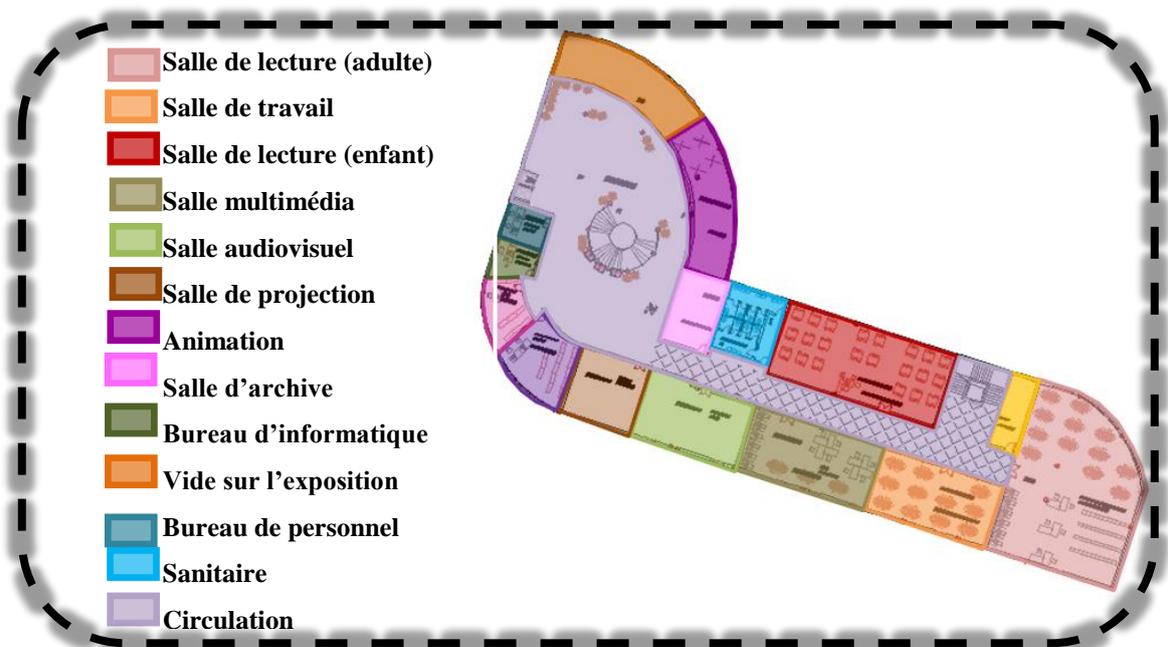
Plan du 3<sup>ème</sup> étage
